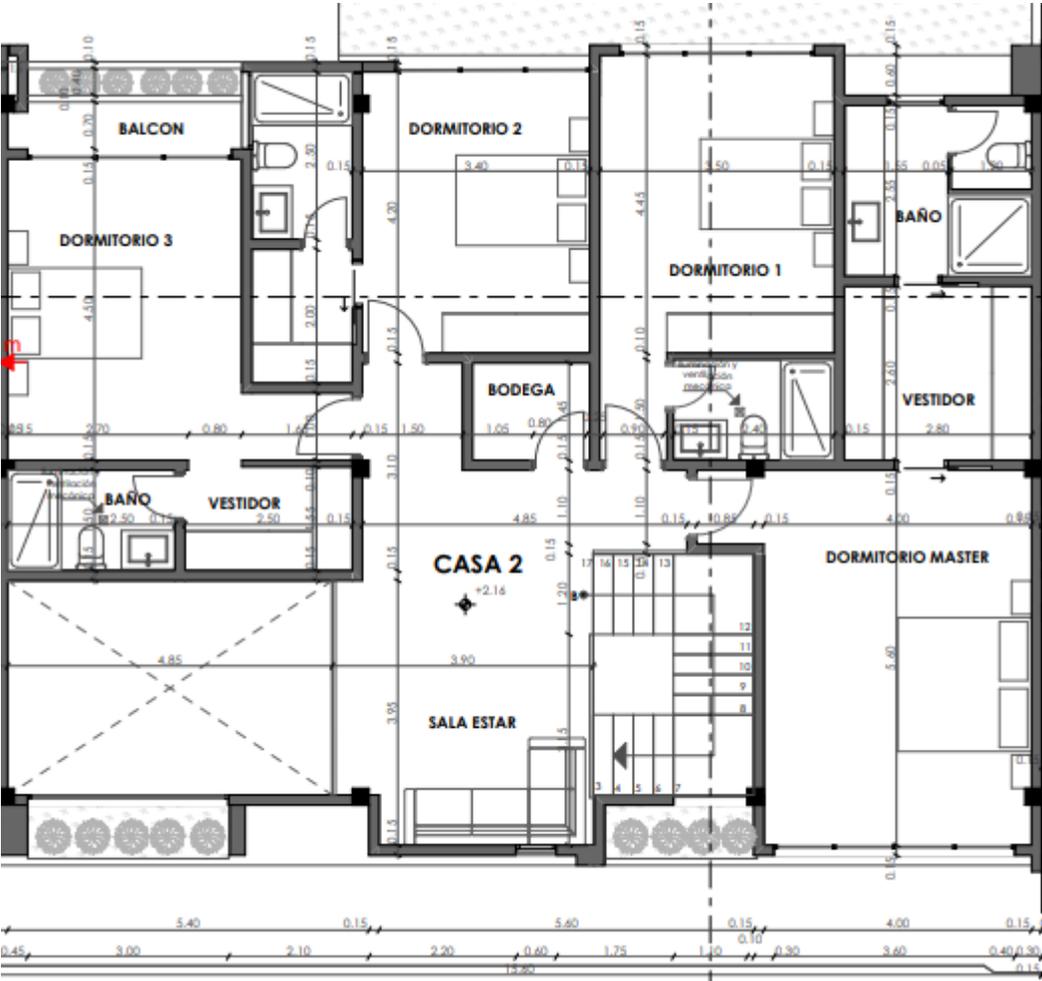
Plano de Planta Alta del Condominio del Bombero
